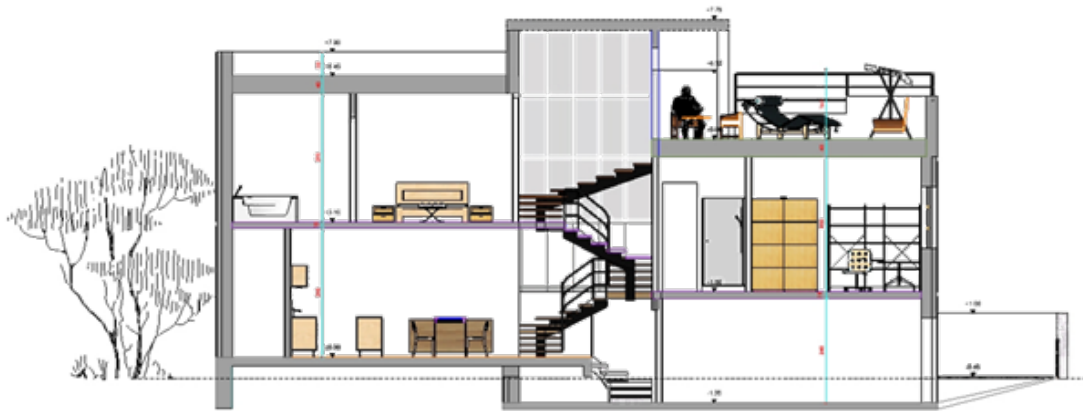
Secțiune longitudinală prin corpul cu dormitoare și garaj/Longitudinal section through bedrooms and garage
